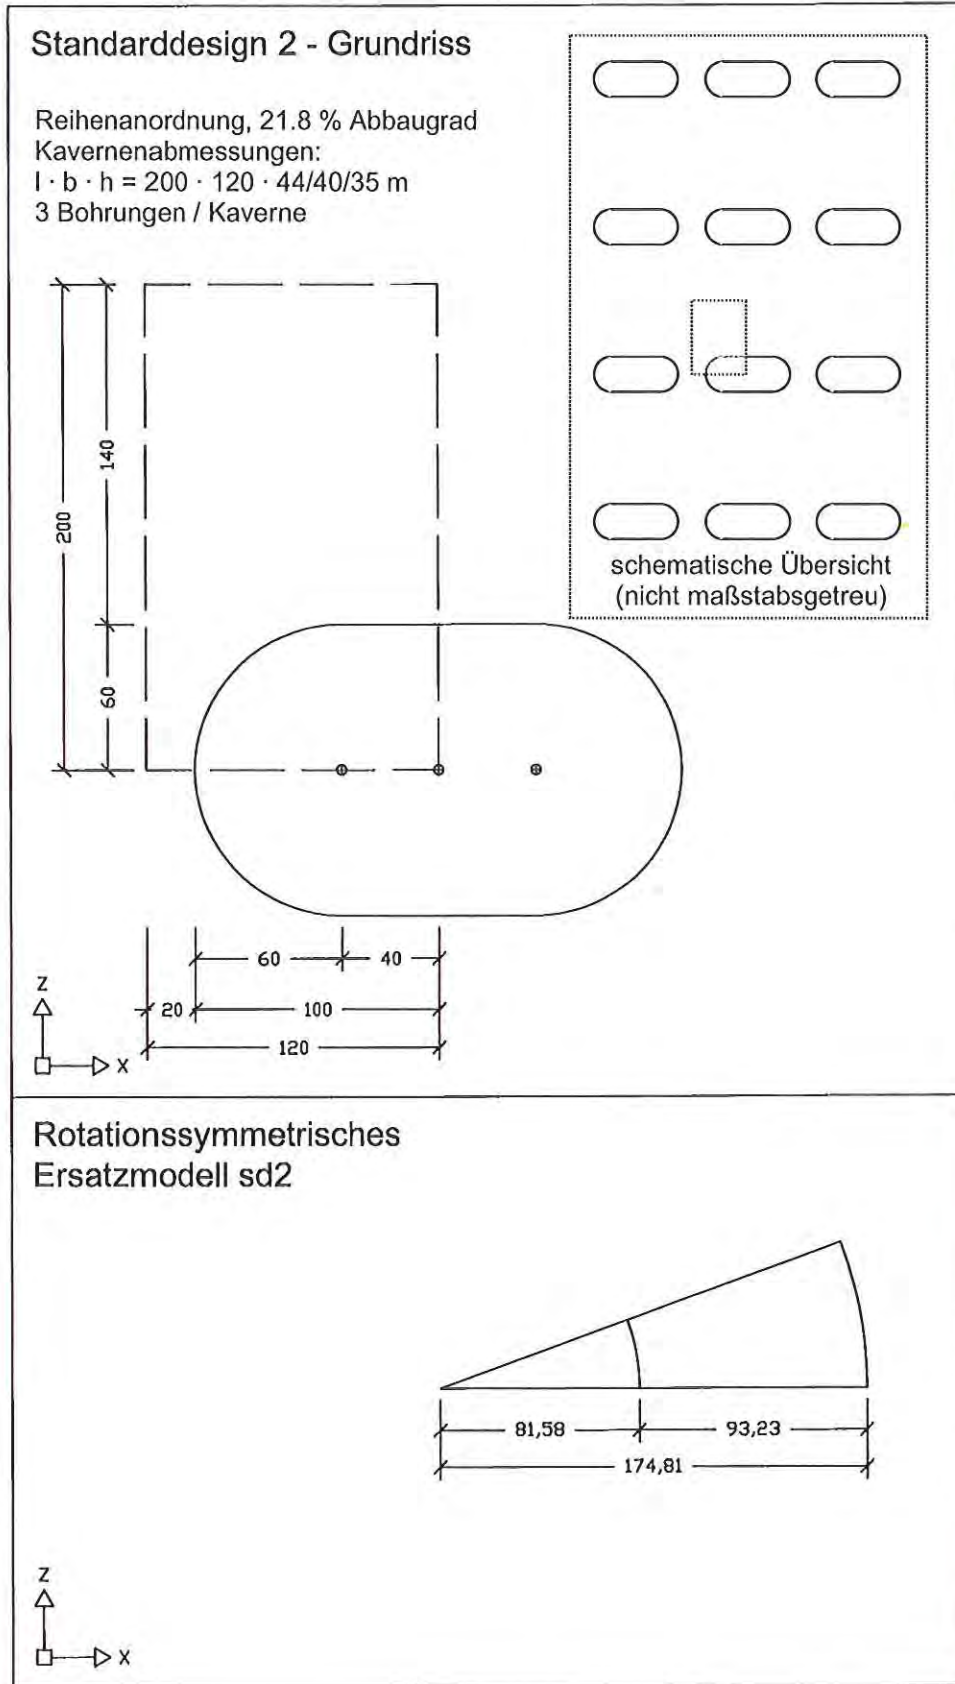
Standarddesign 2 – Grundriss und rotationssymmetrisches Ersatzmodell
